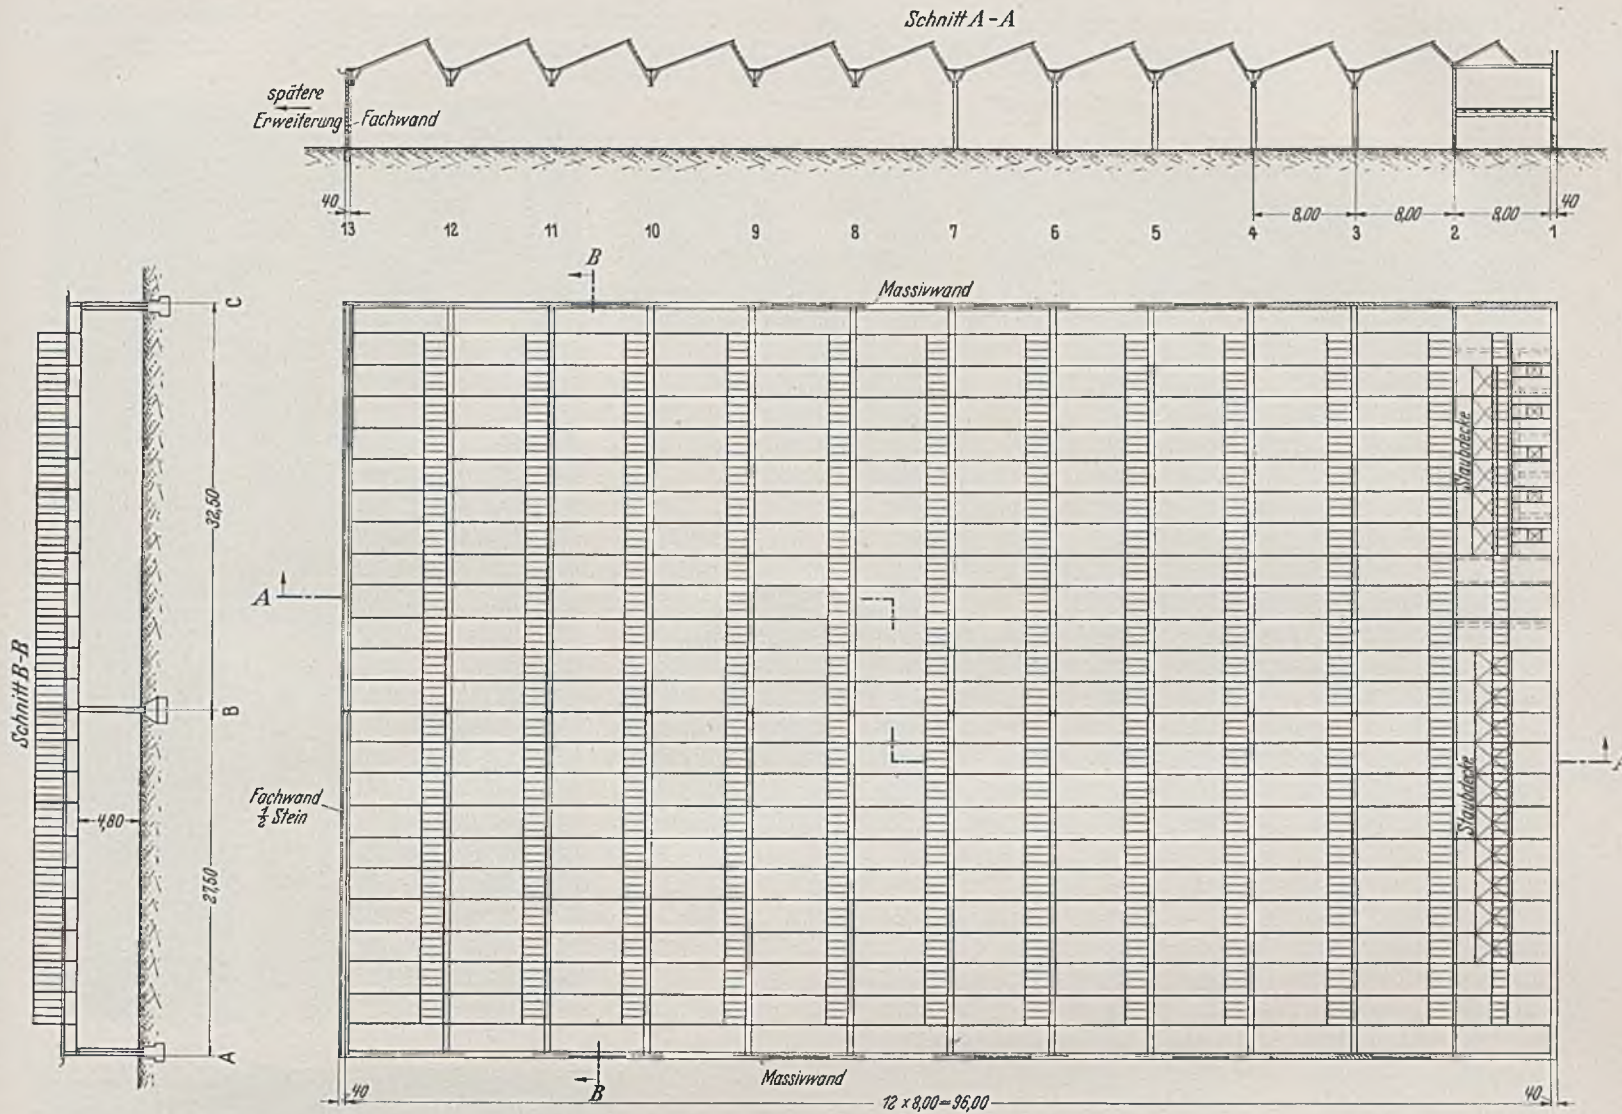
Bau 6: Grundriß, Quer- und Längenschnitt.
